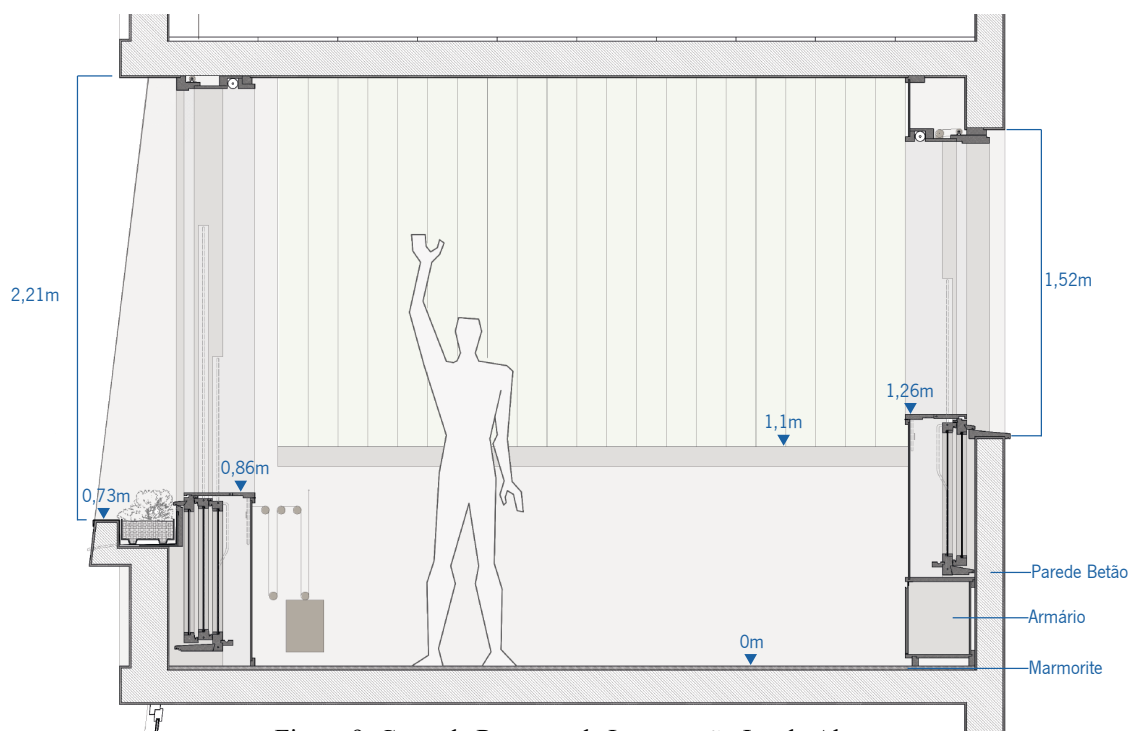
Corte da Proposta de Intervenção Janela Aberta
